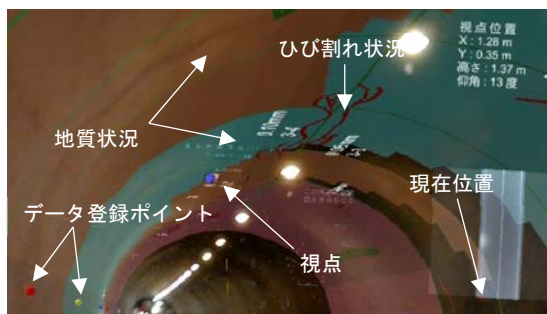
地質状況及び覆工ひび割れ状況 (仮想)
